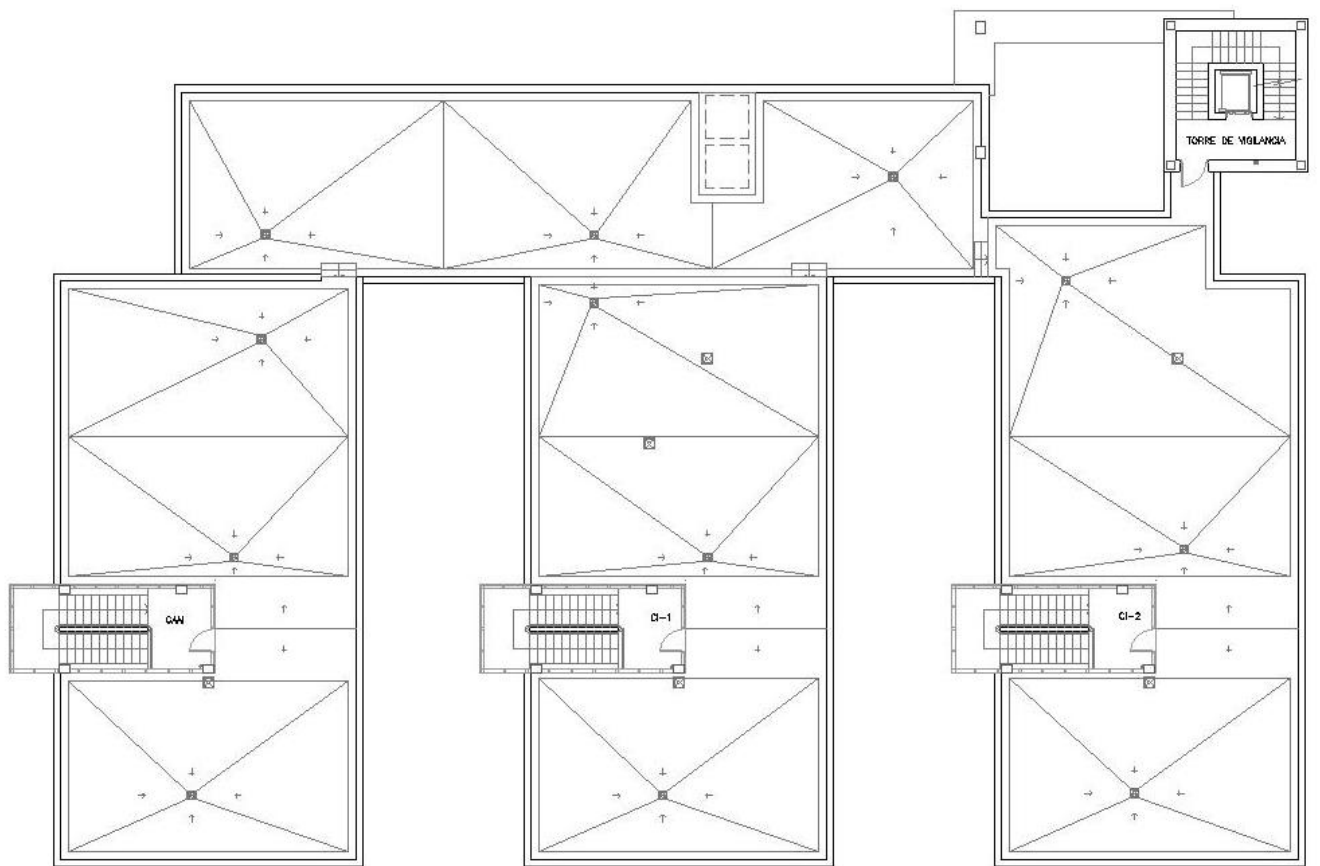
Planta de cubierta. Fuente: Proyecto técnico de ejecución.
